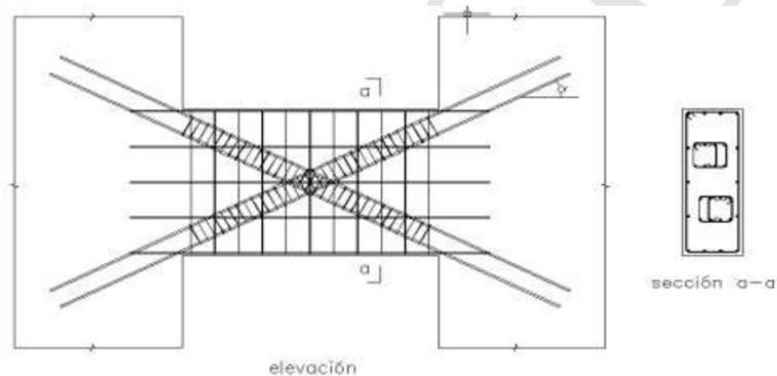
i Refuerzo de vigas de acople
